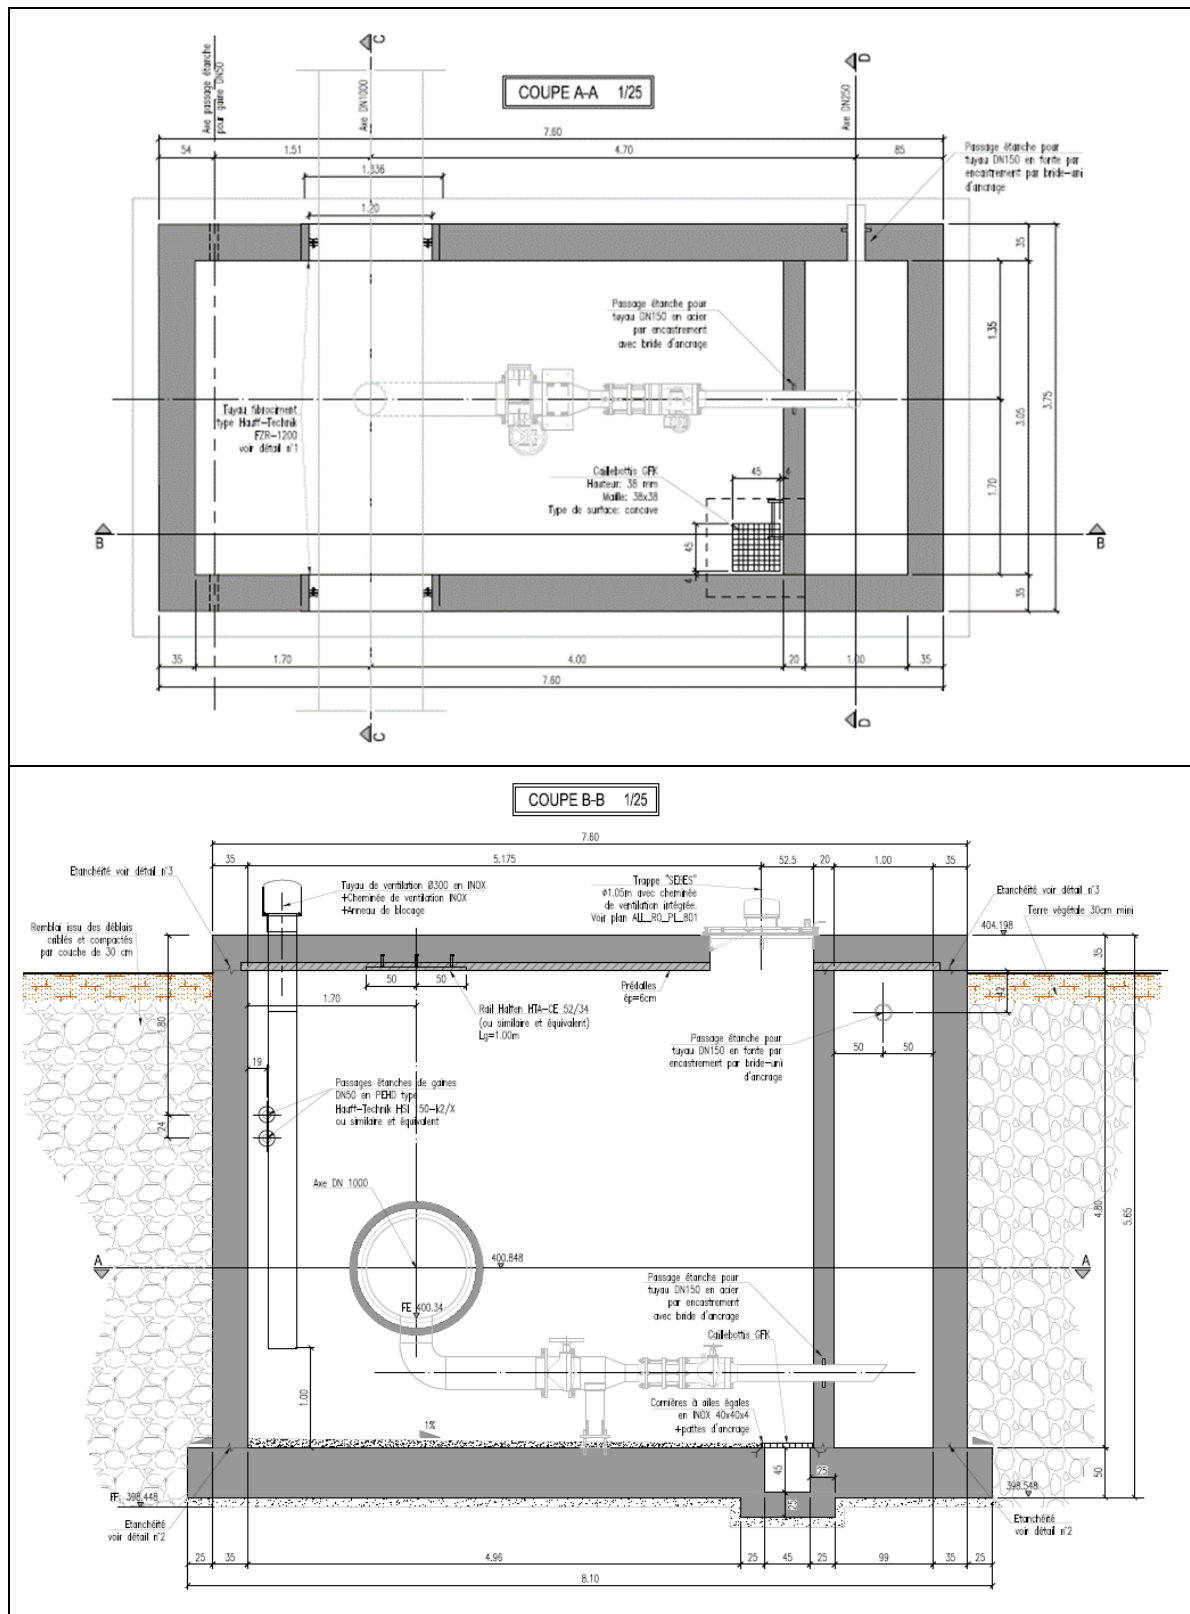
Grundriss und Querschnitt Tiefpunkt (PB)
